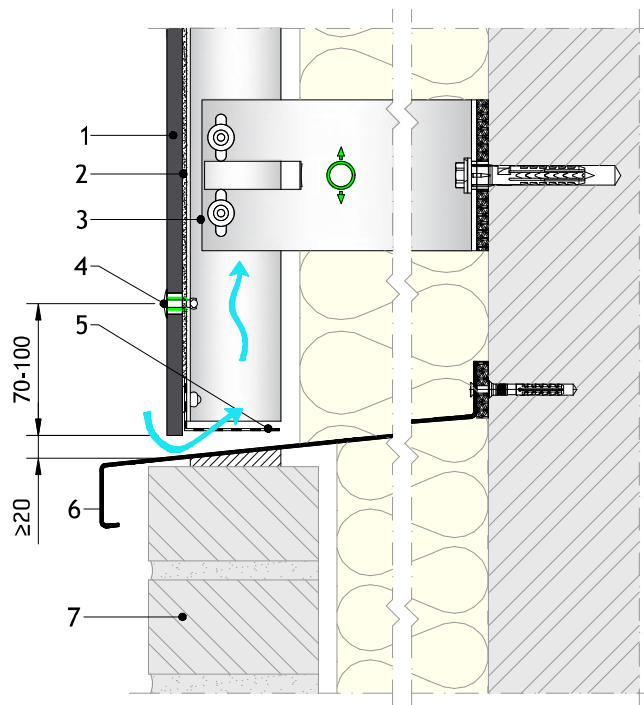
Kombinationsfassaden - Klinkerfassader (horizontal)
